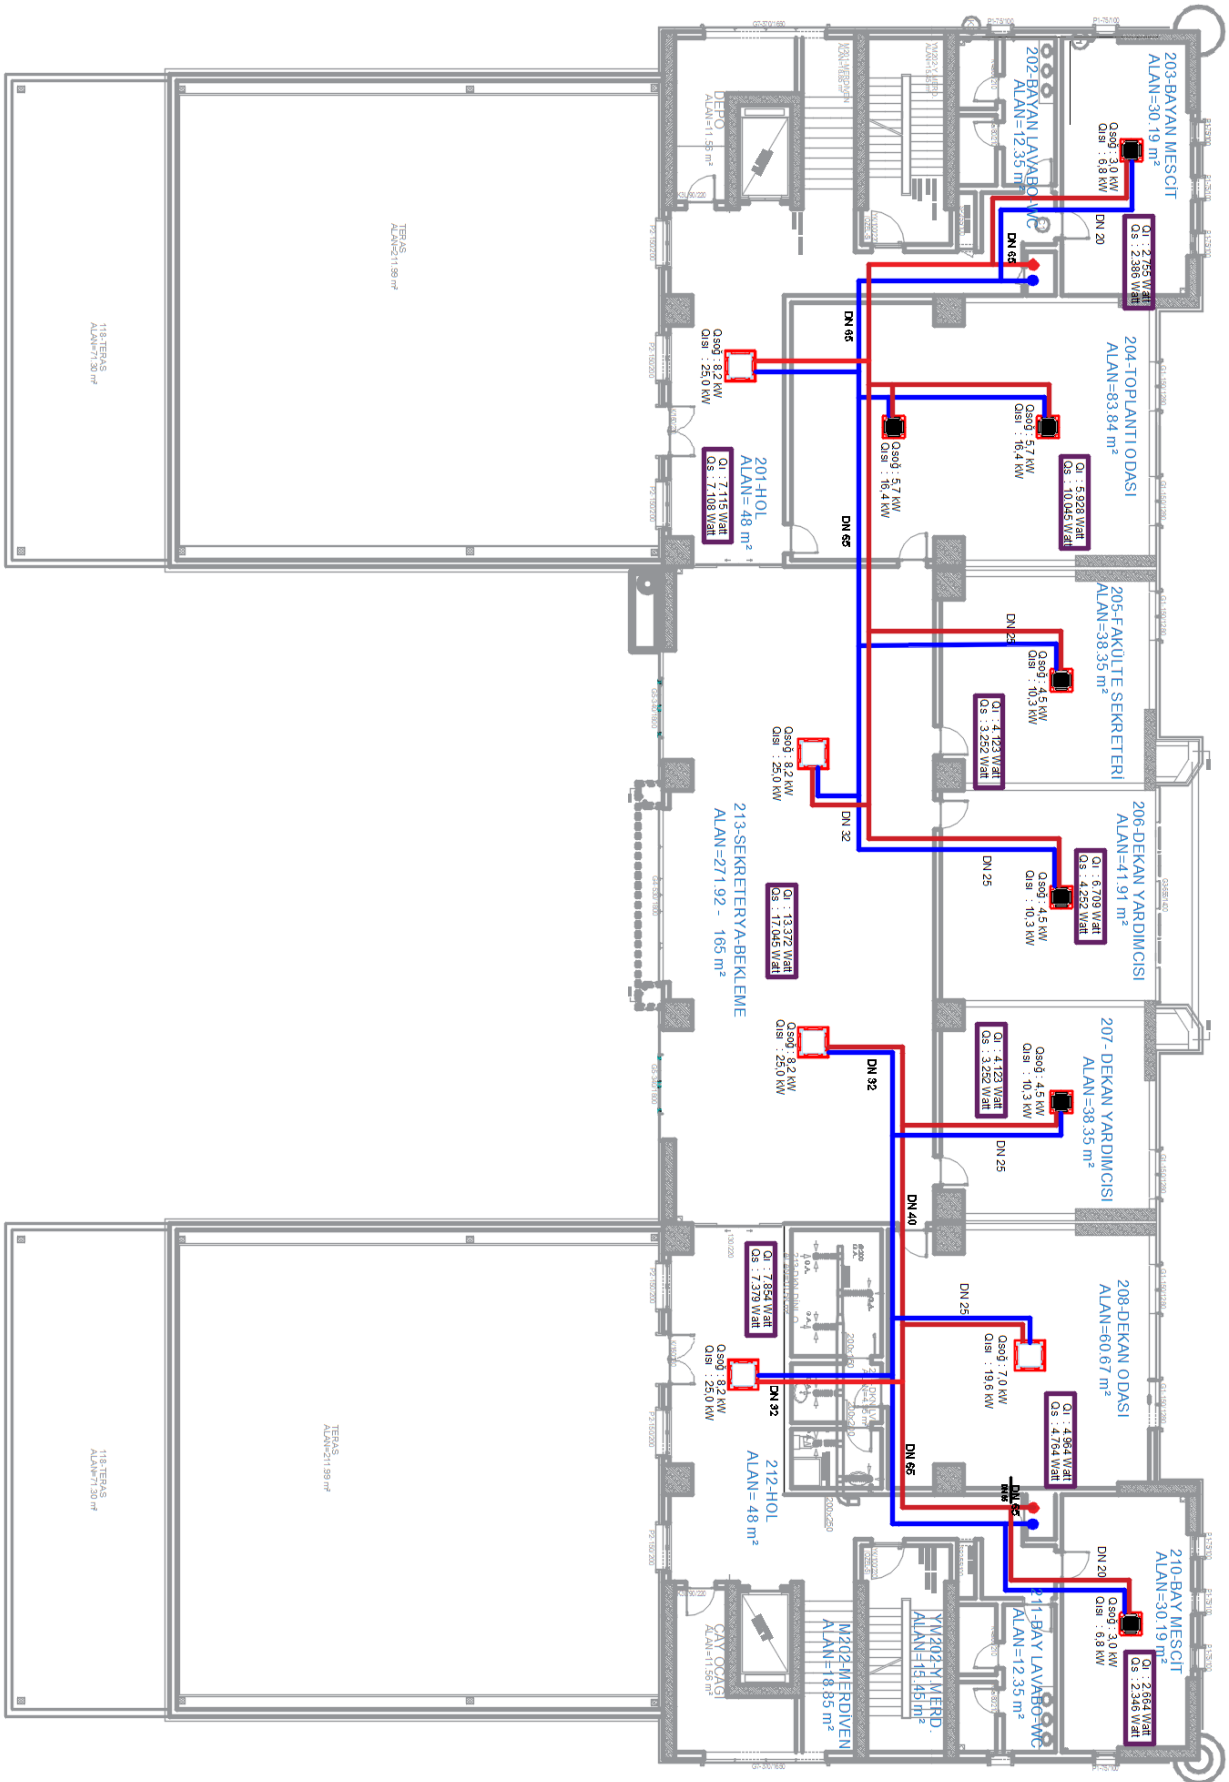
Fan coil tesisatı 2. bodrum kat planı.
